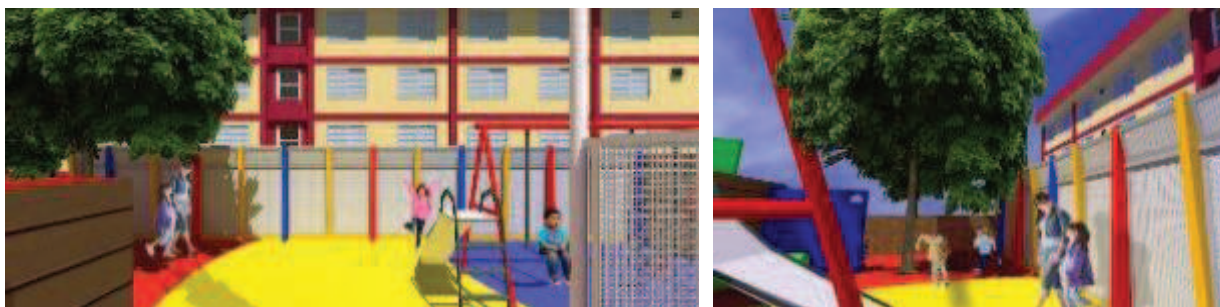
Implantação do projeto da barreira acústica do playground da escola UP
